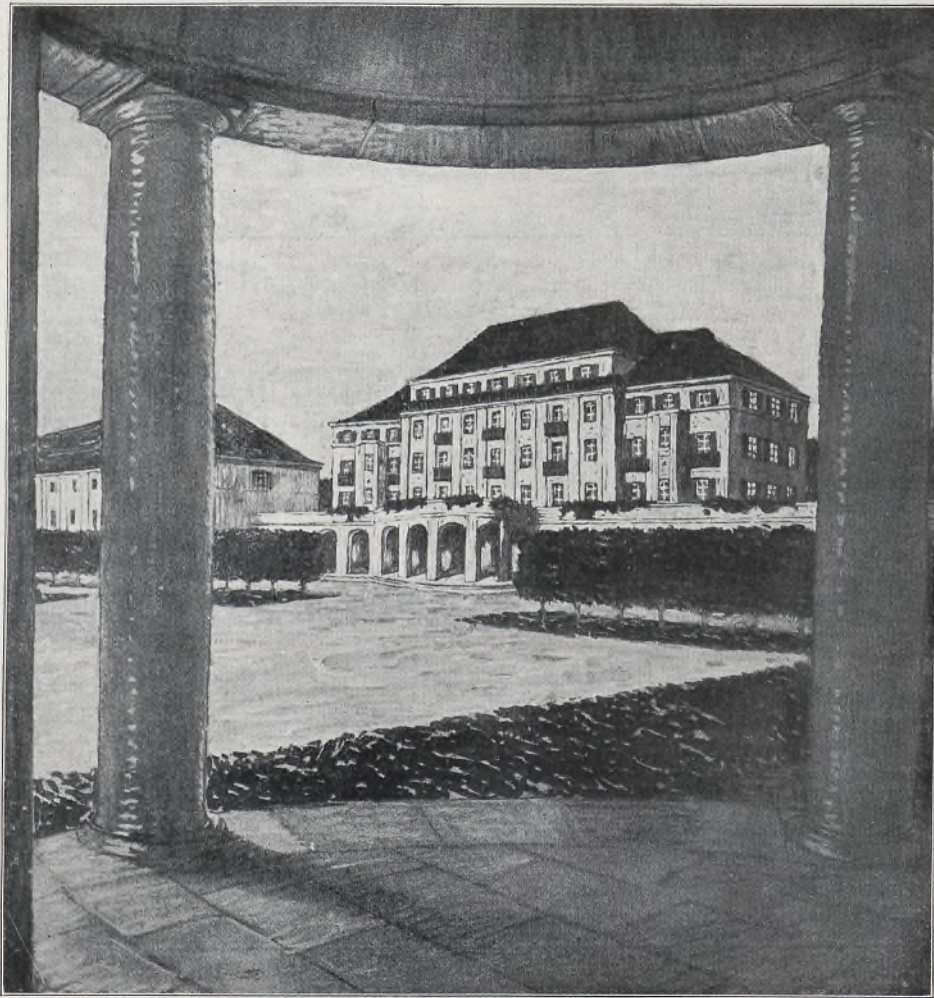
Aus dem Bebauungsplan für Sankt Joachimsthal in Böhmen.
